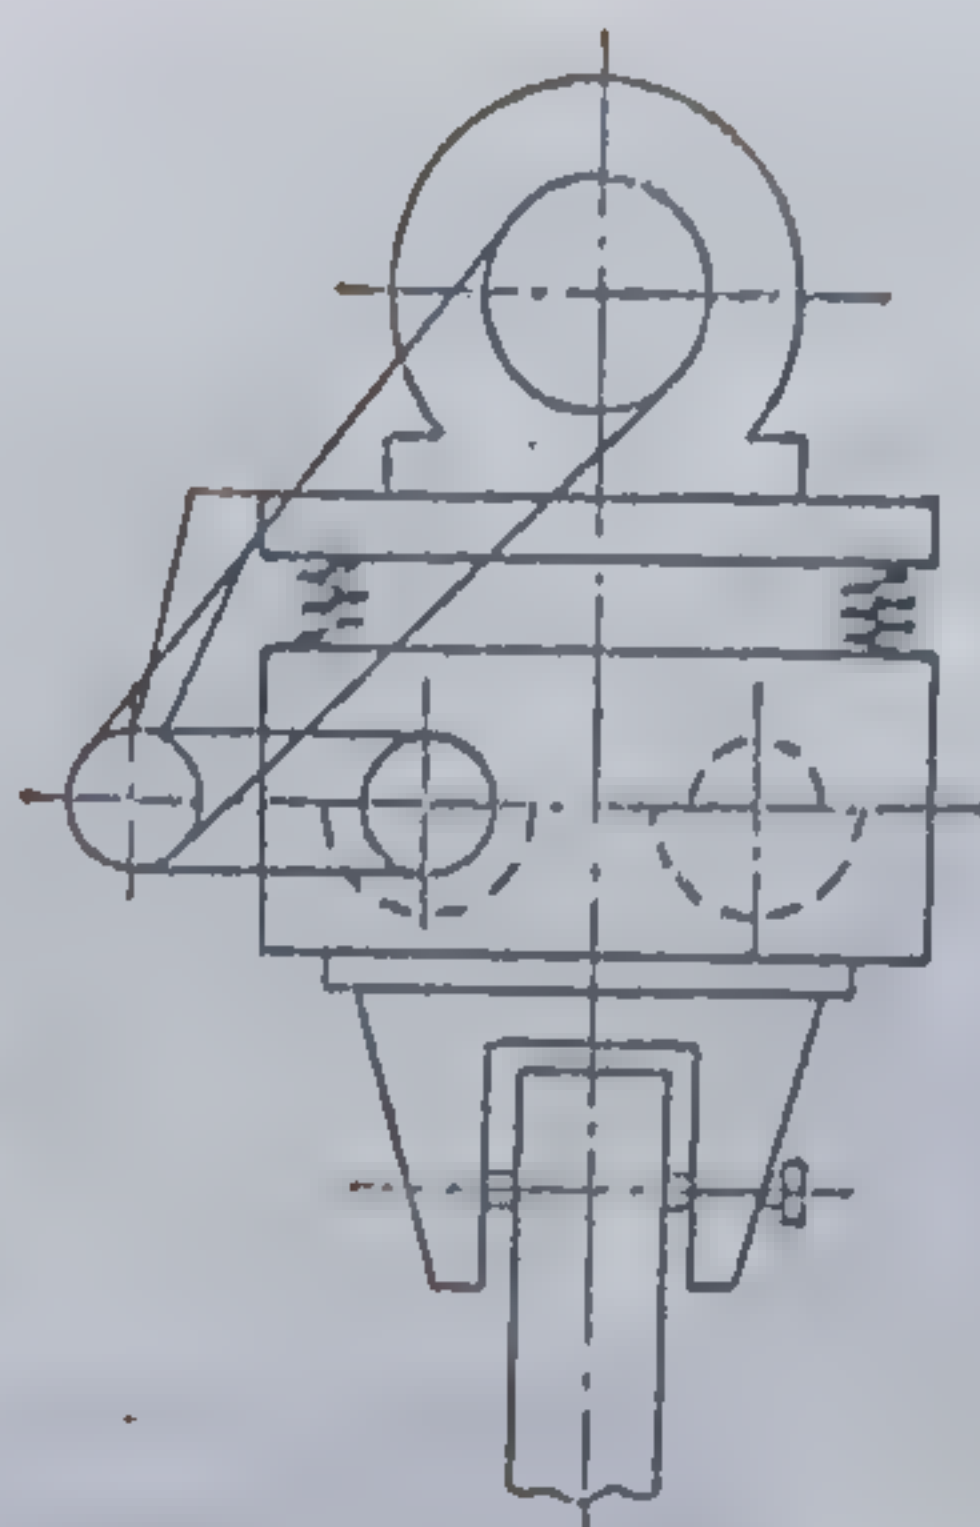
Vibrator cu excentrice, cu prindere elastică a motorului.
